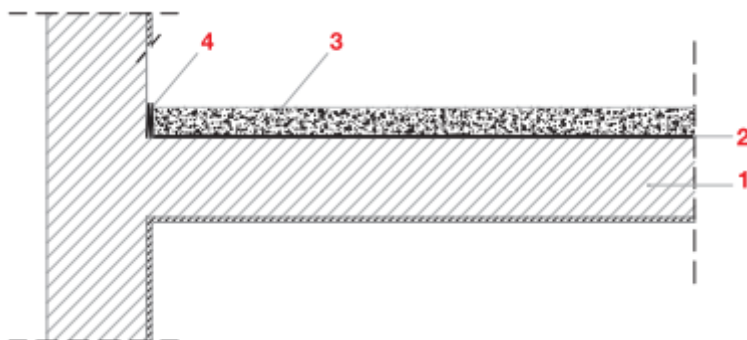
Betonilha Aderente. 1)Laje; 2)Aguada de aderência; 3)Betonilha de espessura<4cm; 4)Material compressível.
